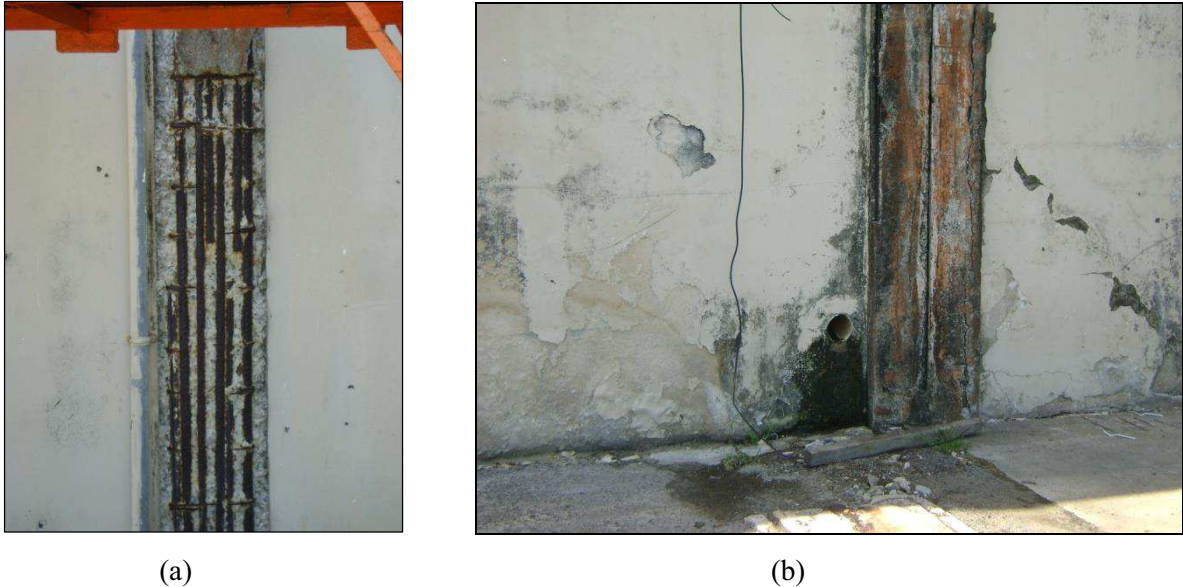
(a) Pilar apresentando extensa área de armadura exposta e (b) tubo de queda de águas pluviais próximo ao pilar.
